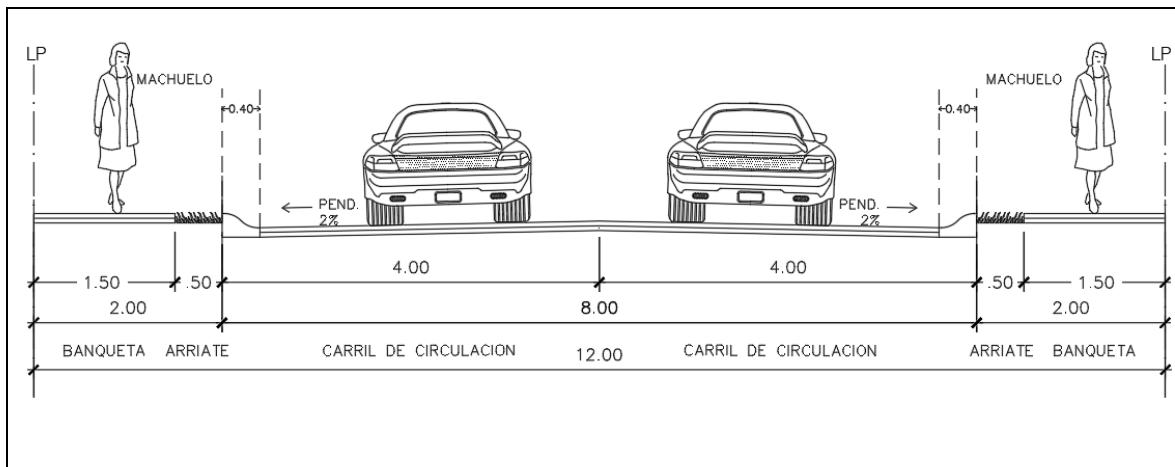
Sección vial en vialidades colectoras publicas tipo "B"
